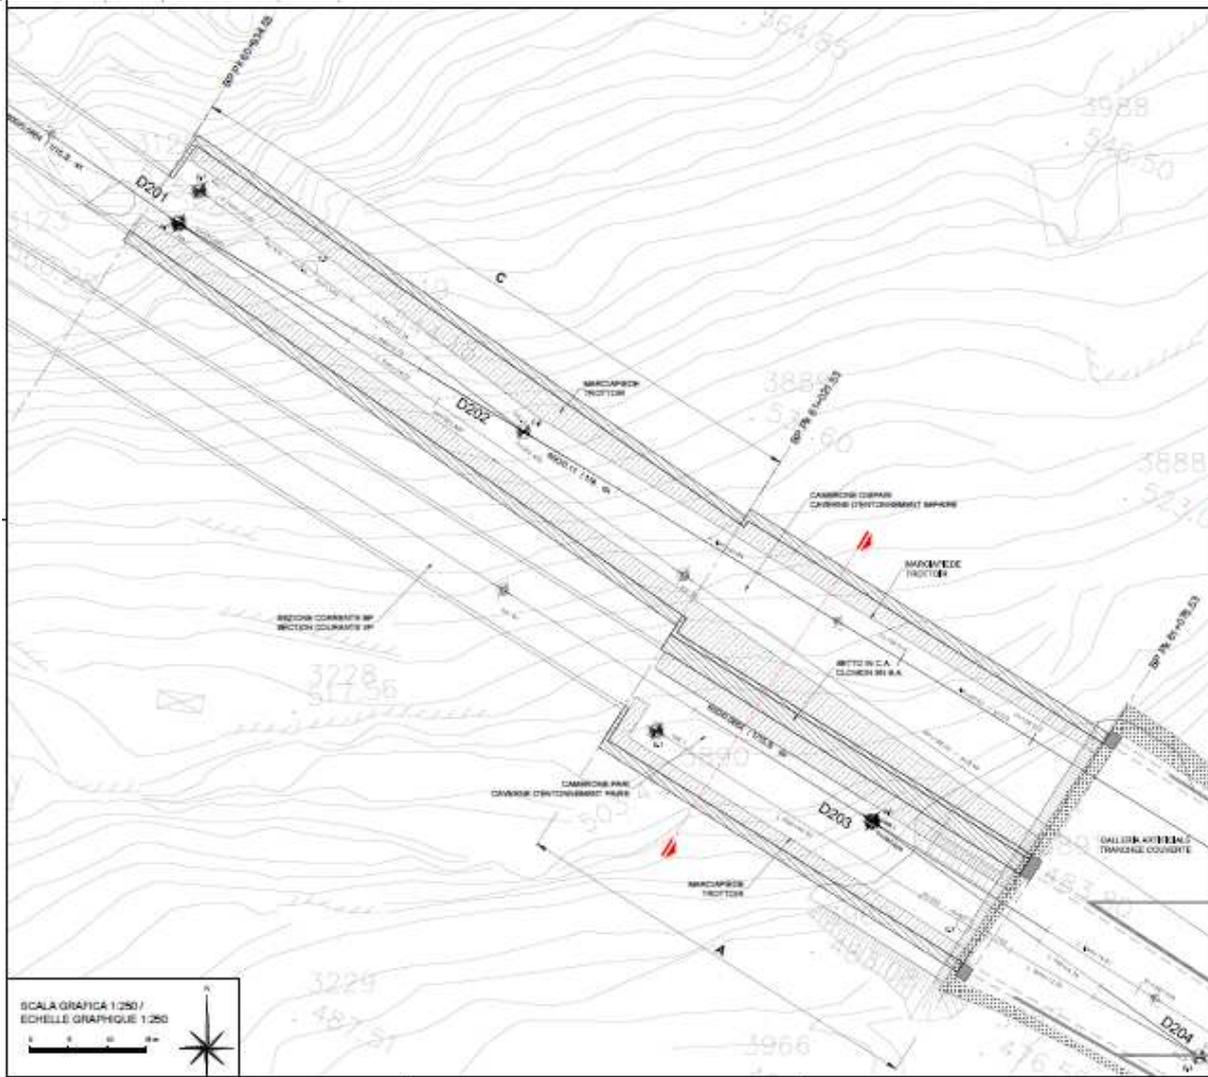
Planimetria nella zona degli imbocchi a Susa
